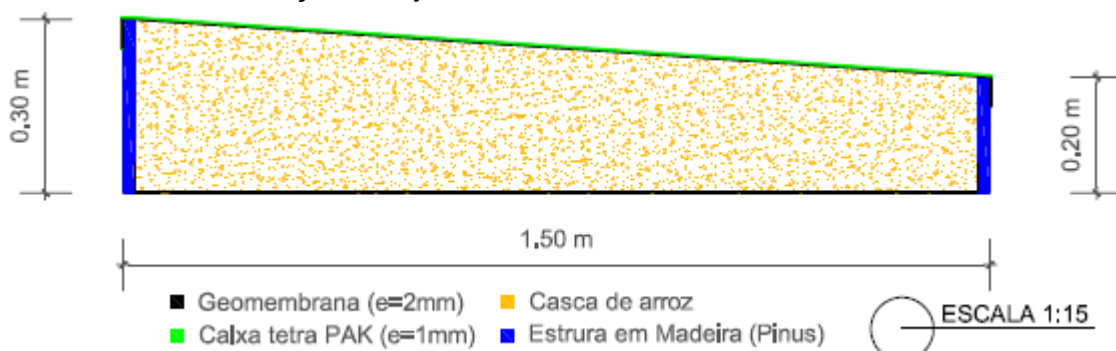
Croqui das camadas e estrutura do sistema de isolamento proposto
